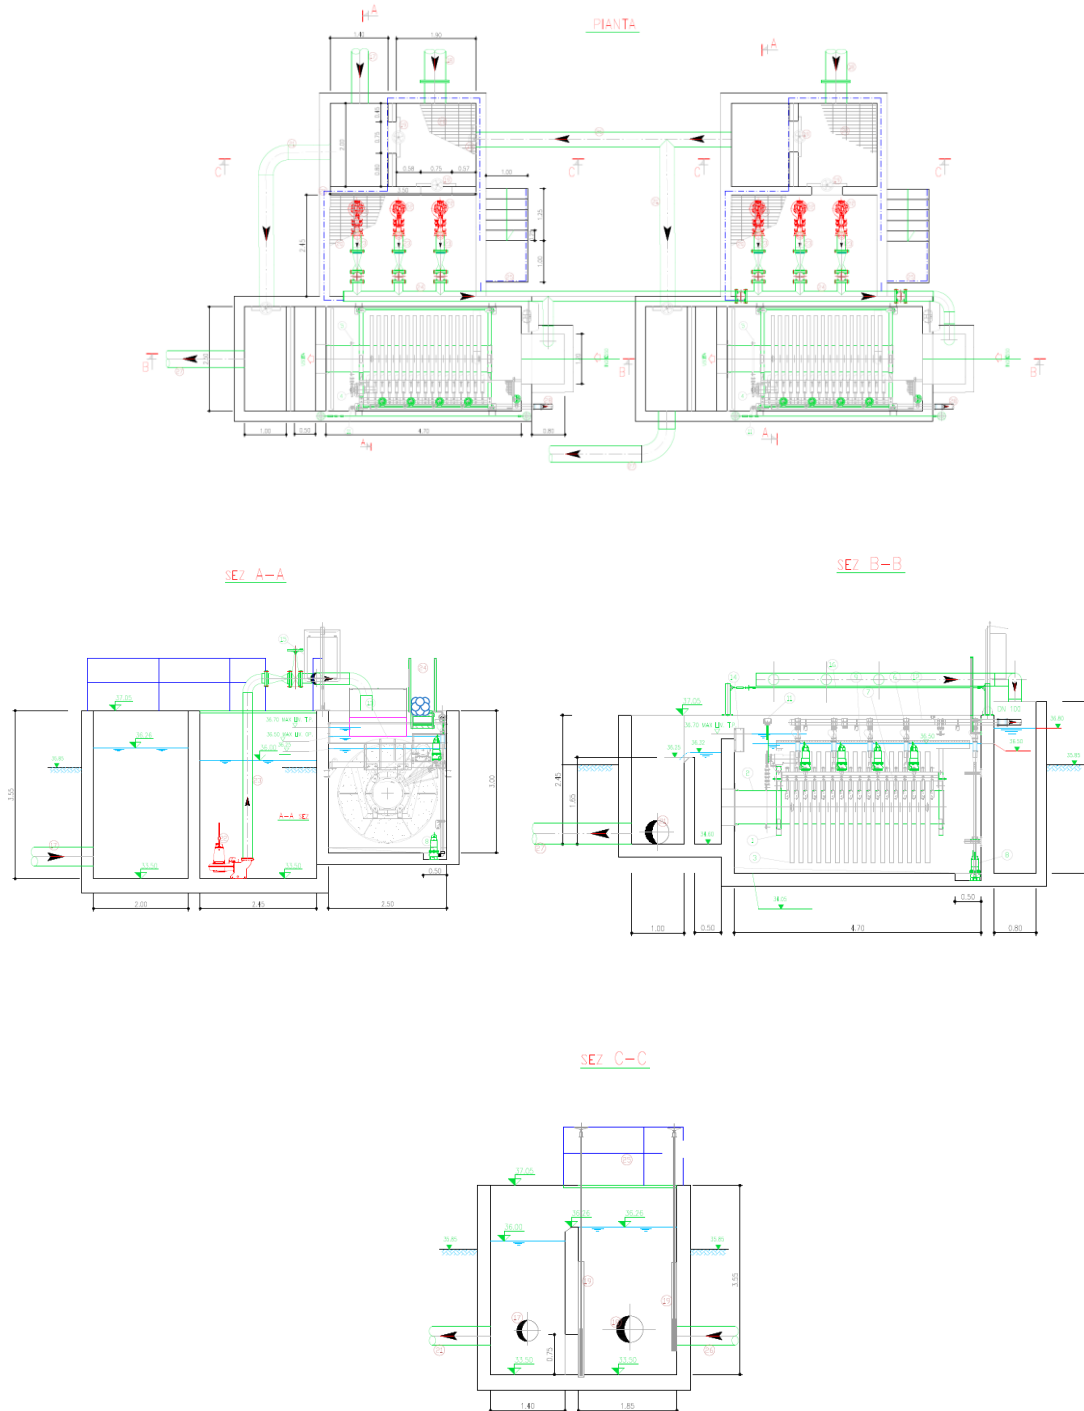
Pianta e sezione nuova stazione di Filtrazione
